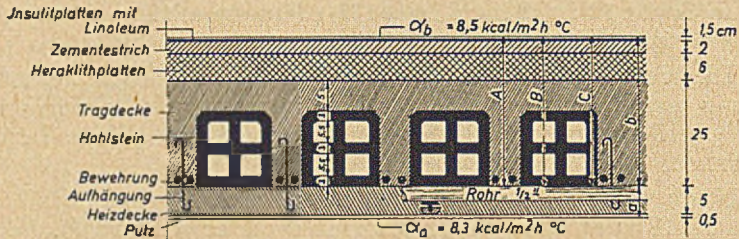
Hohlsteindecke zum Berechnungsbeispiel.
